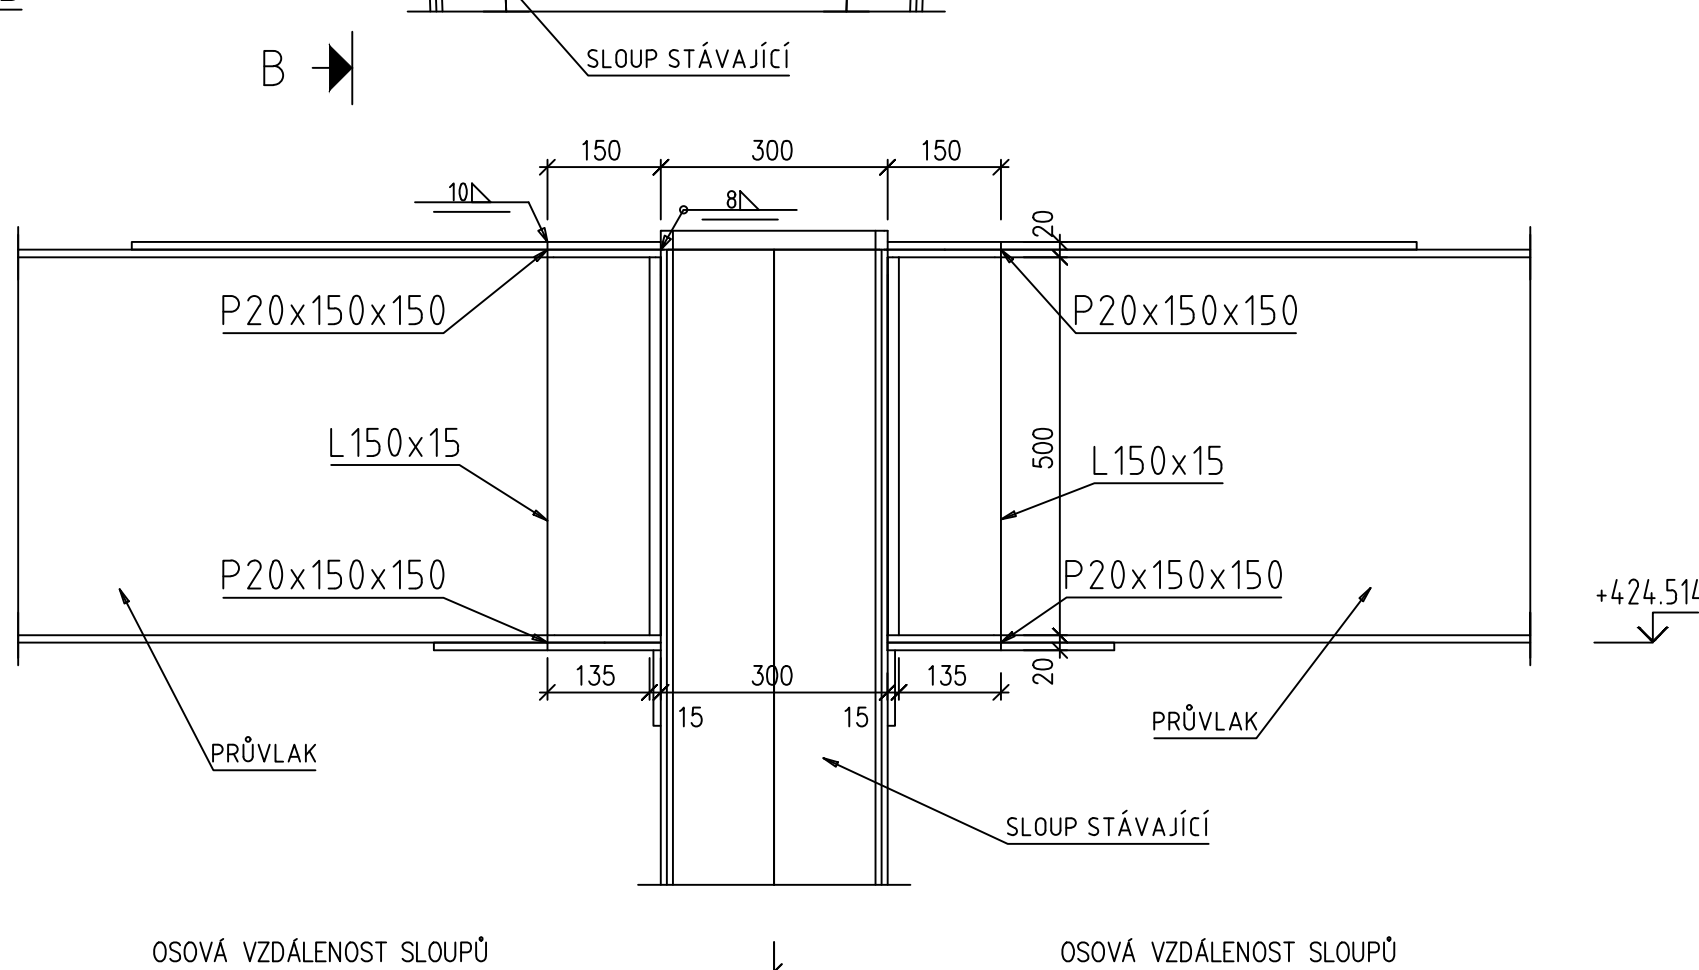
ÚPRAVA STÁVAJÍCÍHO SPOJE
